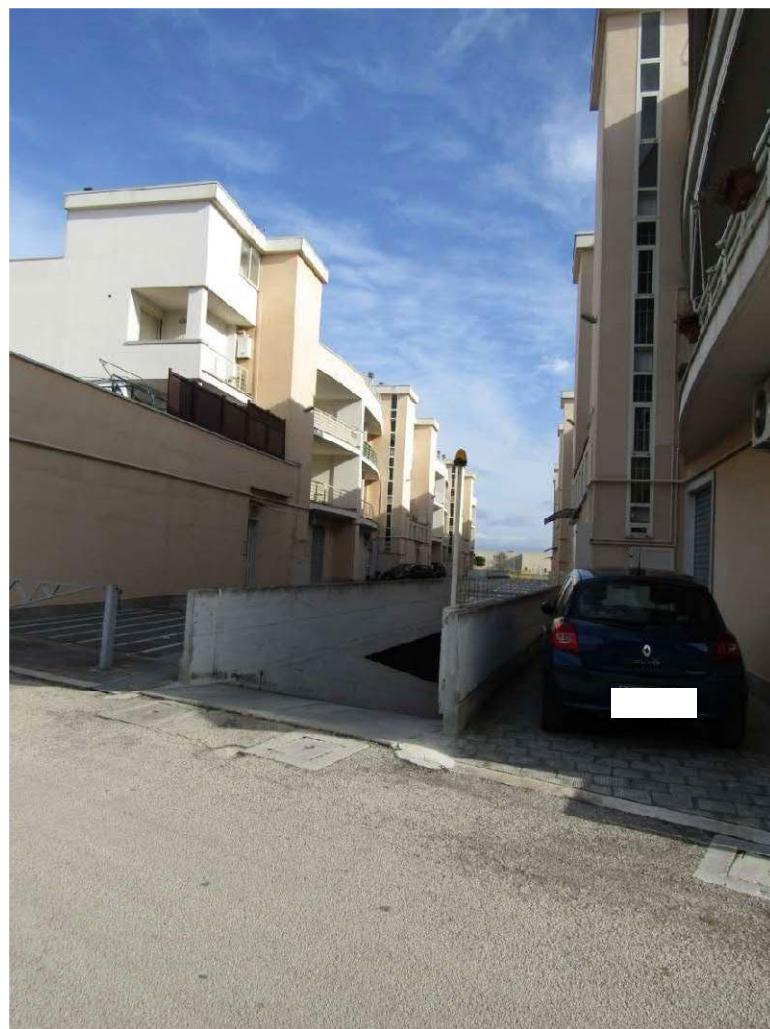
LOTTO 23 – BOX AUTO IN FOGGIA – FABBRICATO B – RAMPA DI ACCESSO AI BOX INTERRATI
